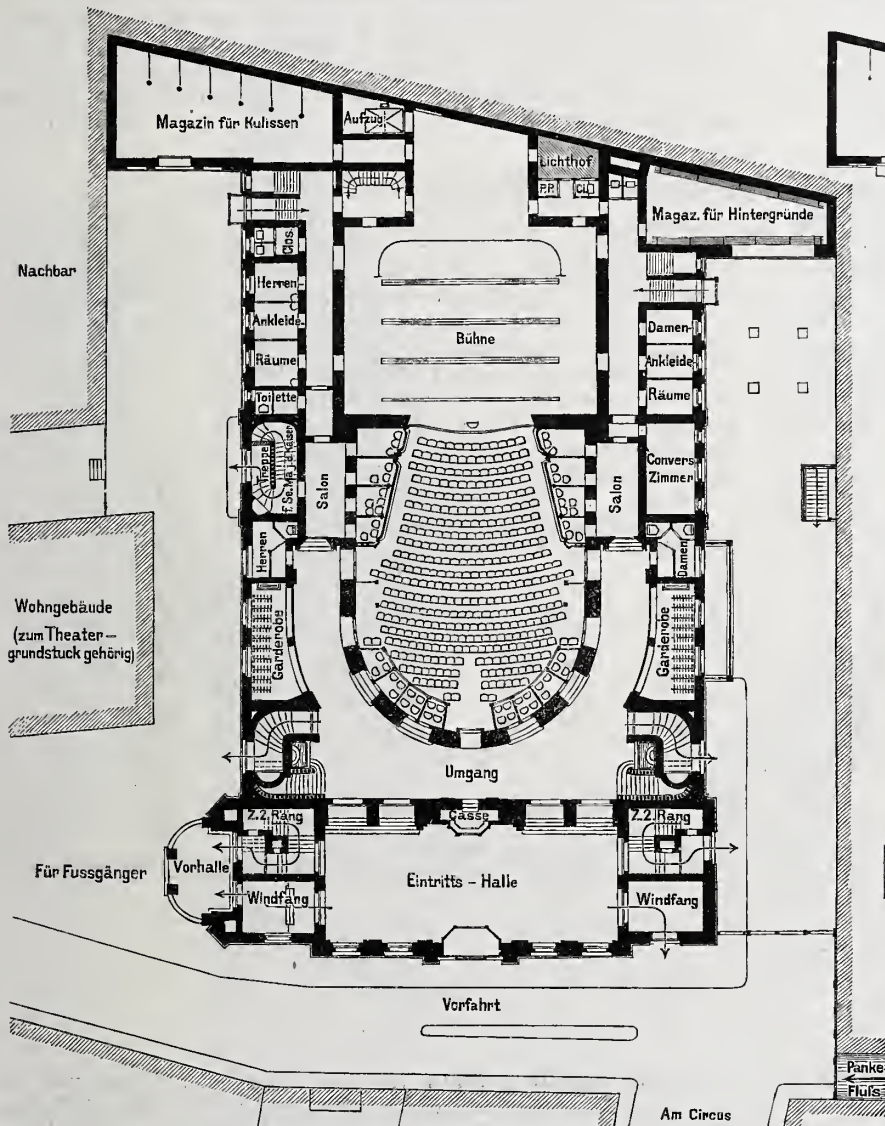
Grundriß des Parketts (Erdgeschoss).
